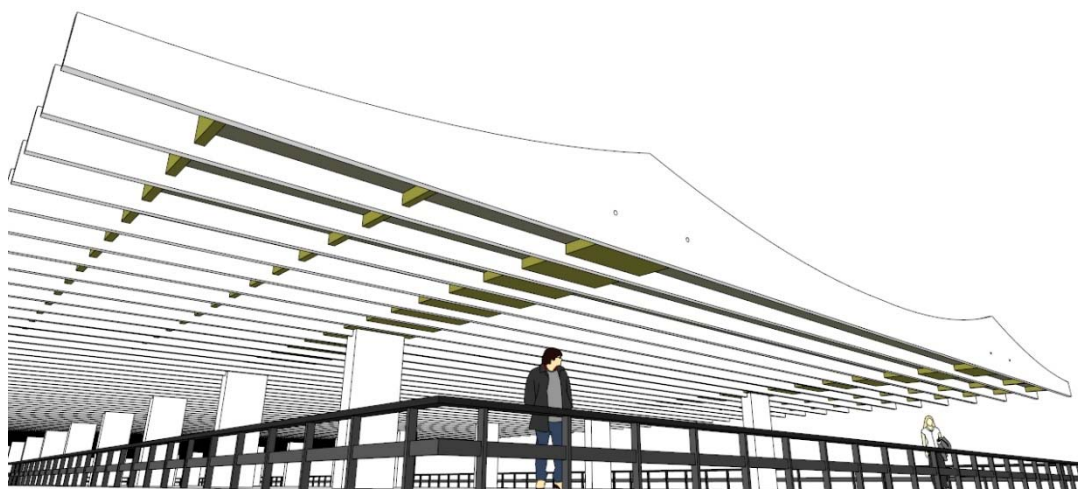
Detalhe da viga mestra e da Viga transversal objeto de estudo.
